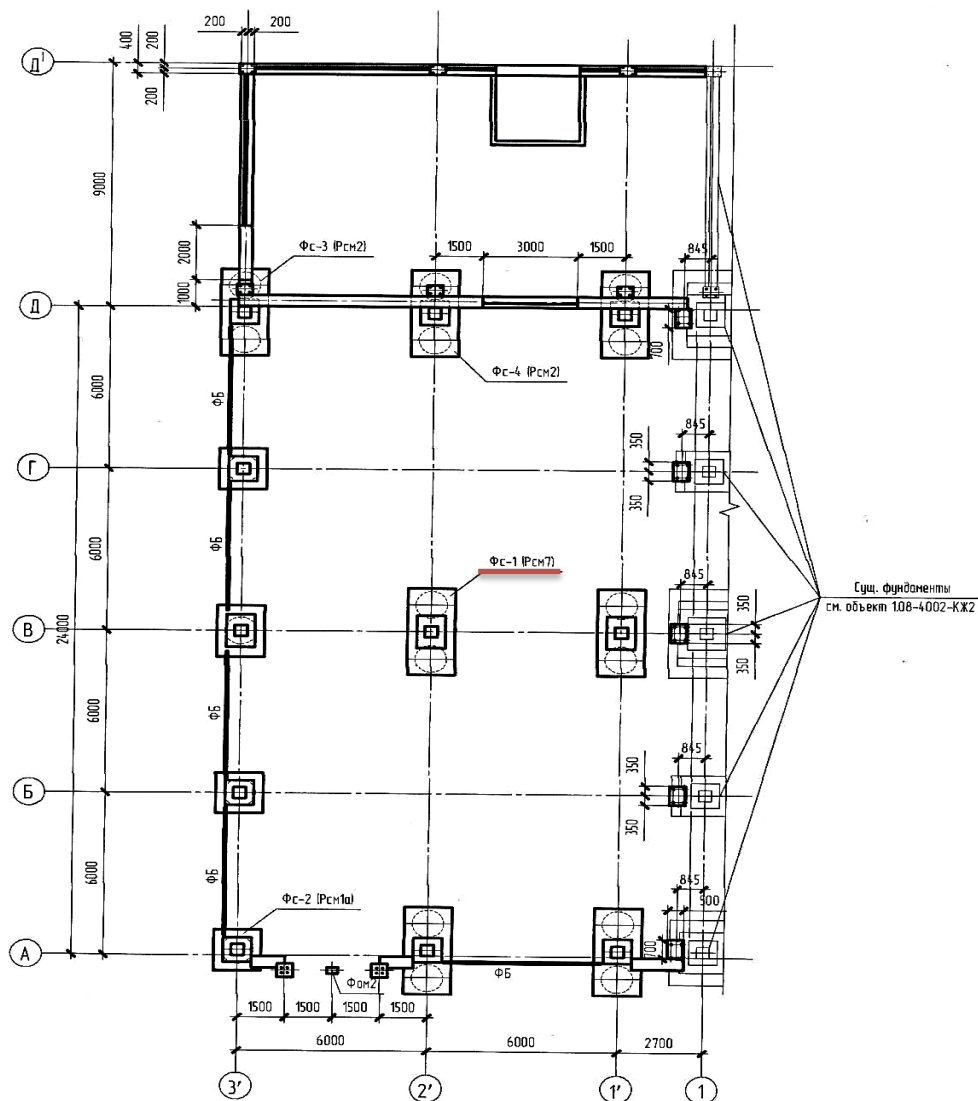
Схема расположения рассчитываемого фундамента
